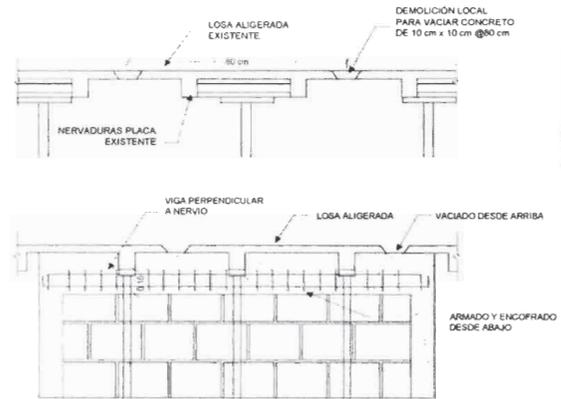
Conexión de muro nuevo a losa existente con nervios. Muro paralelo a los nervios.
